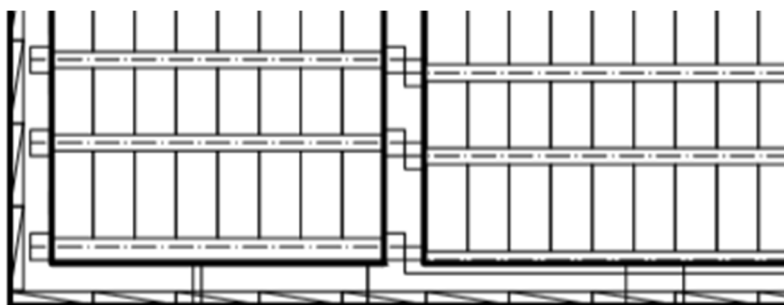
Výřez výkresu základů, objekt typu „A“
